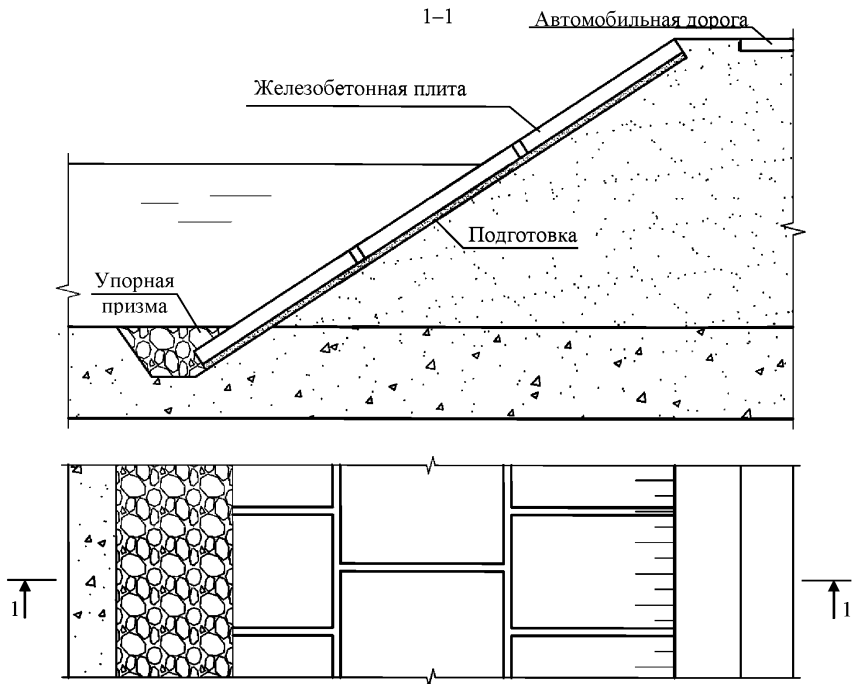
Конструкция откосного сооружения из сборных железобетонных плит
